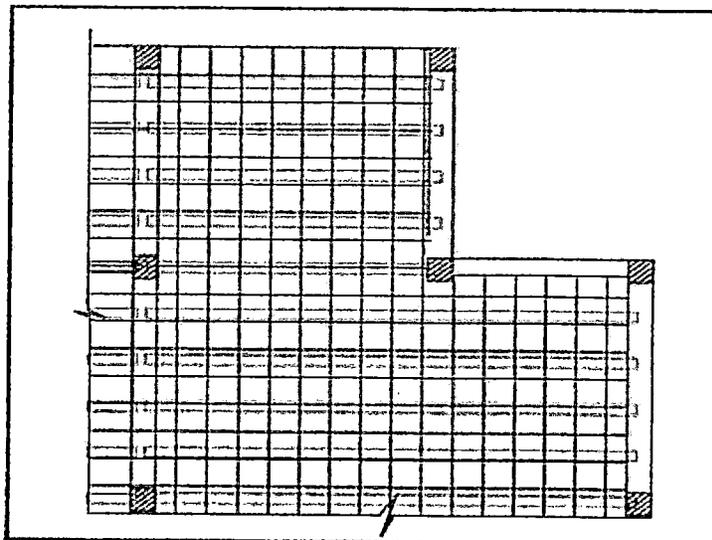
Apuntalamiento de Vigas Chatas paralelas
